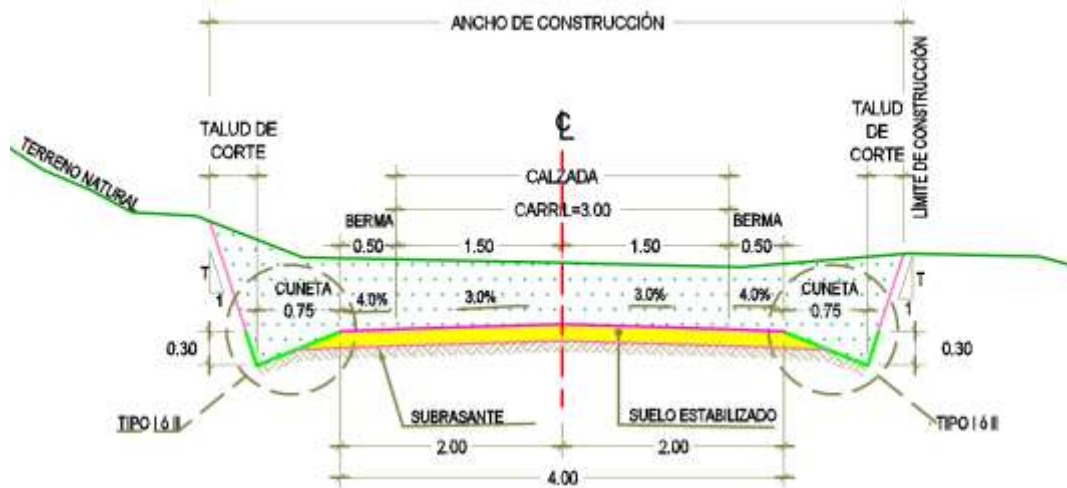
Sección típica en corte cerrado. Fuente: plano de Secciones Típicas.
